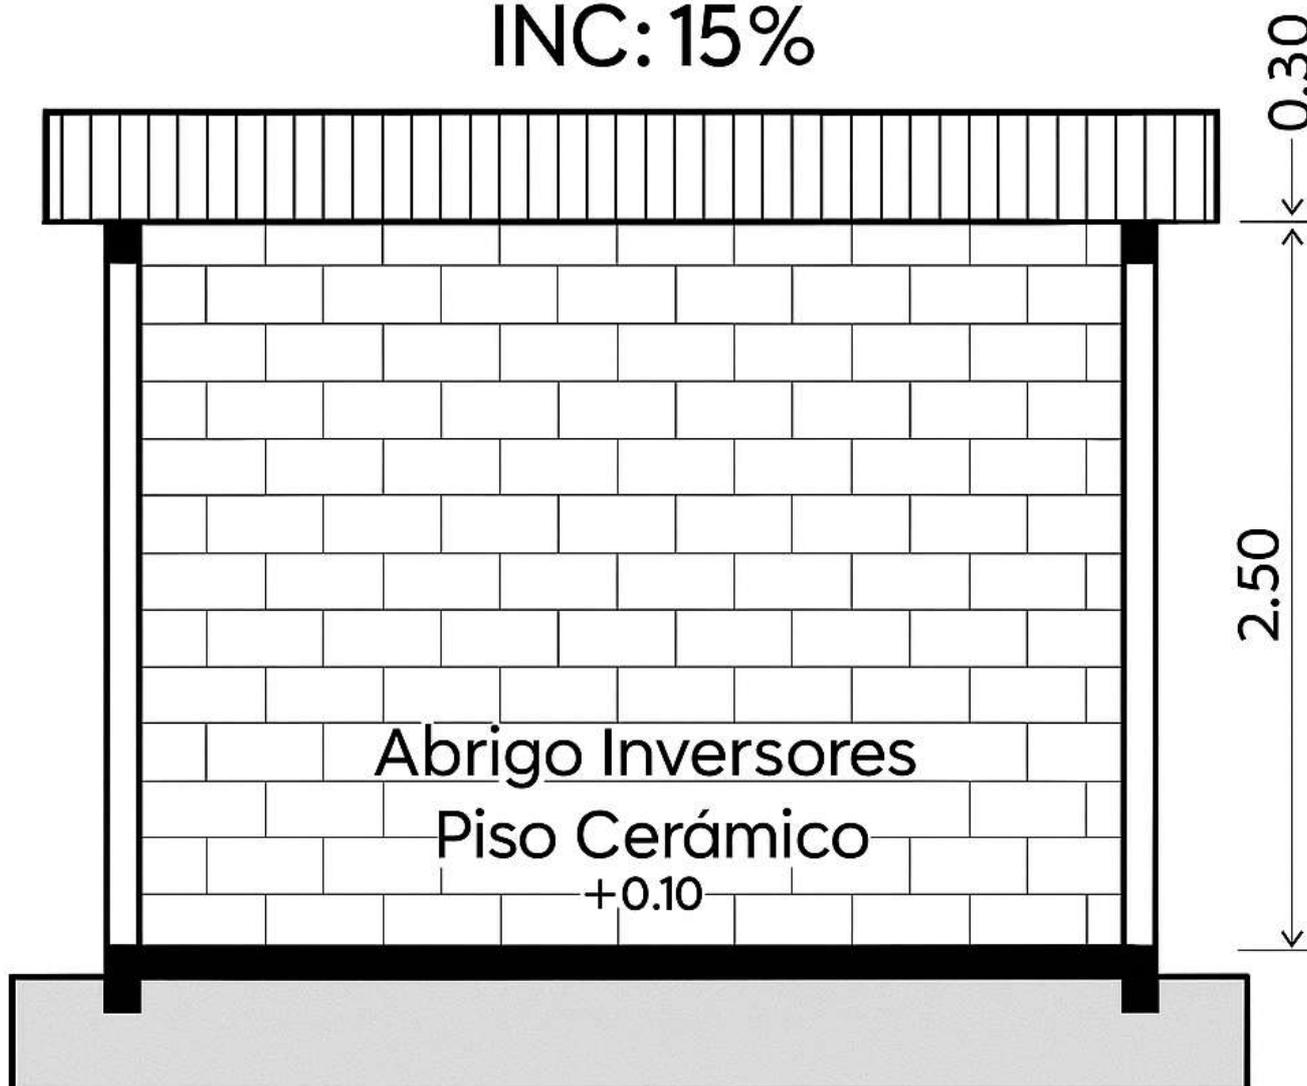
Planta baixa e detalhamentos dos abrigos de inversores II.
